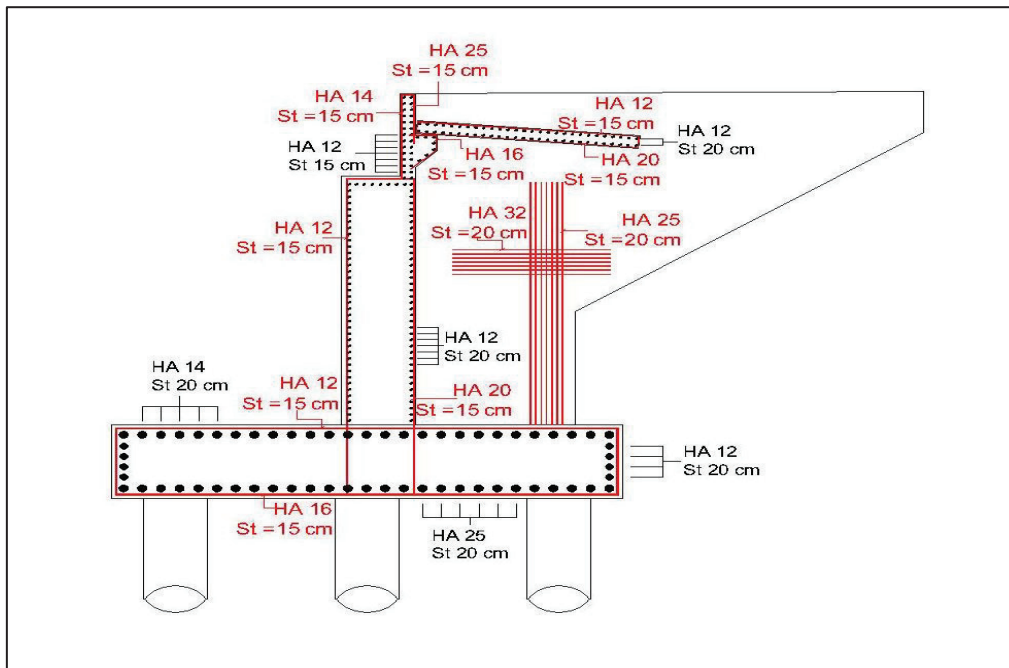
Croquis du ferrailage de la culée et sa fondation
